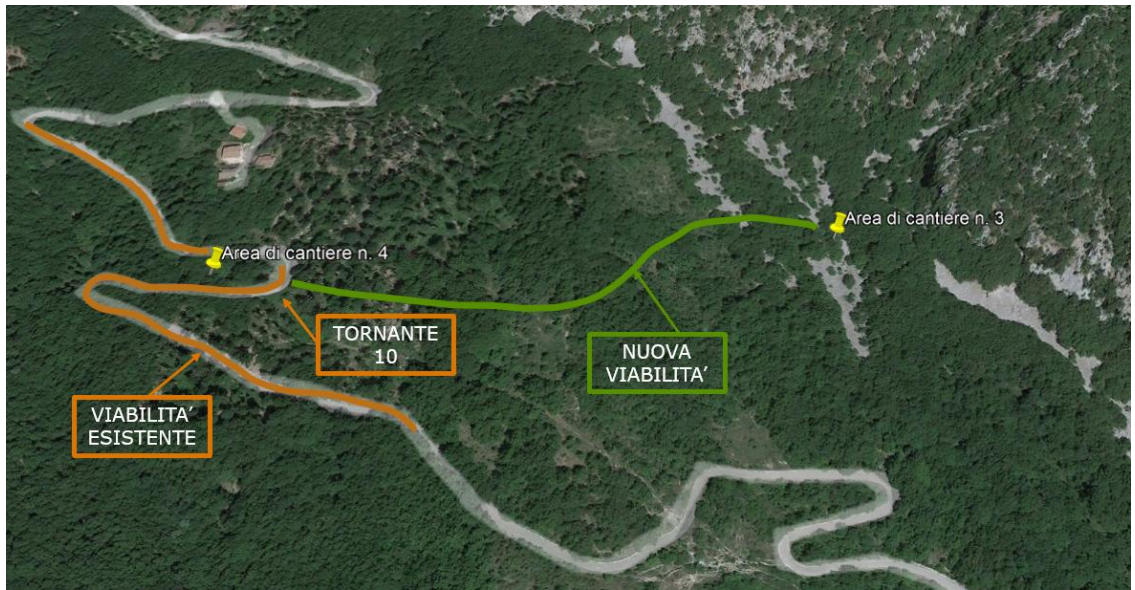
Viabilità di accesso alle aree di cantiere n. 3 e n. 4
